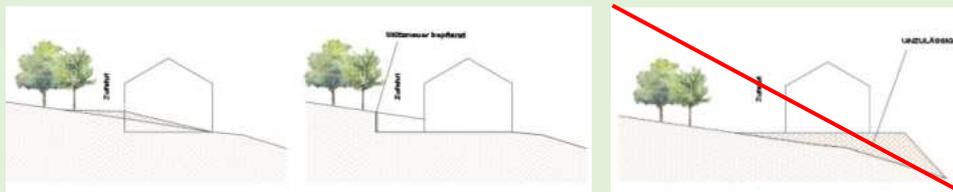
Lage im Hang (Quelle: Entwurfsskizzen Heigl Consulting ZT GmbH)
